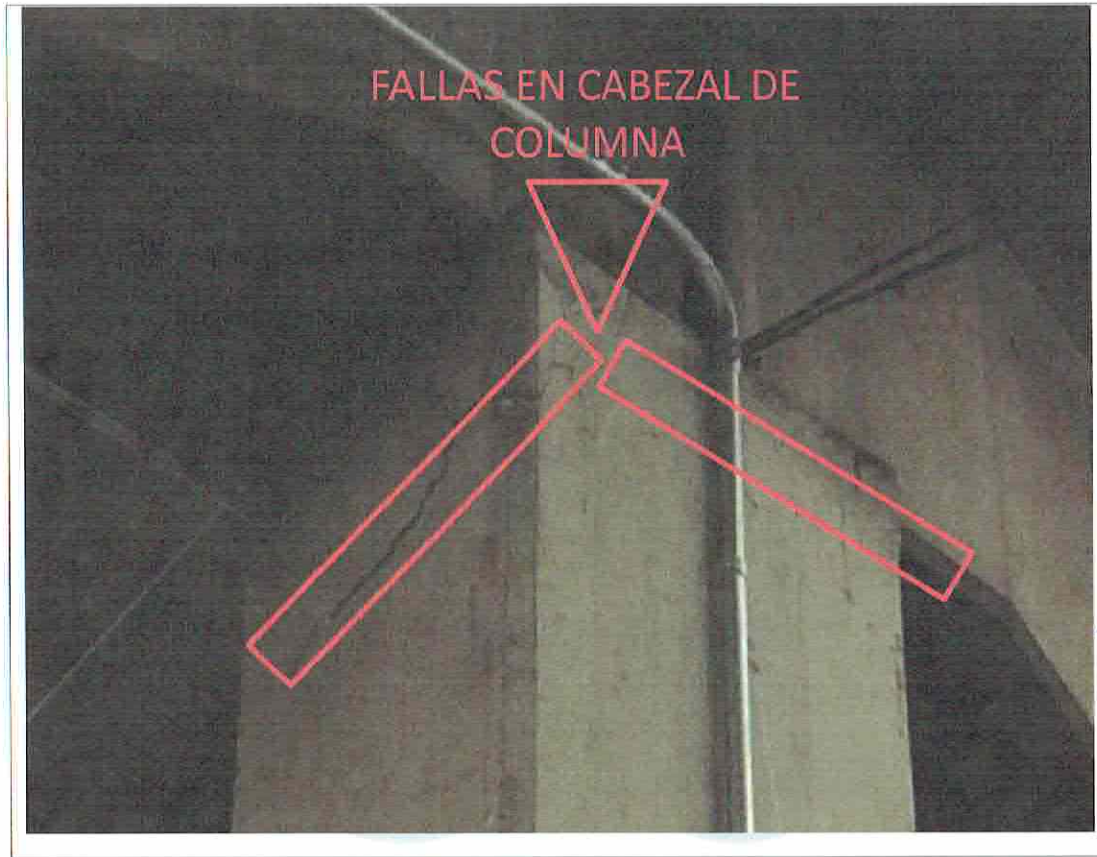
Se muestra más a detalle la presencia de grietas resultantes de falla por flexo-compresión y cortante en el cabezal del elemento.
